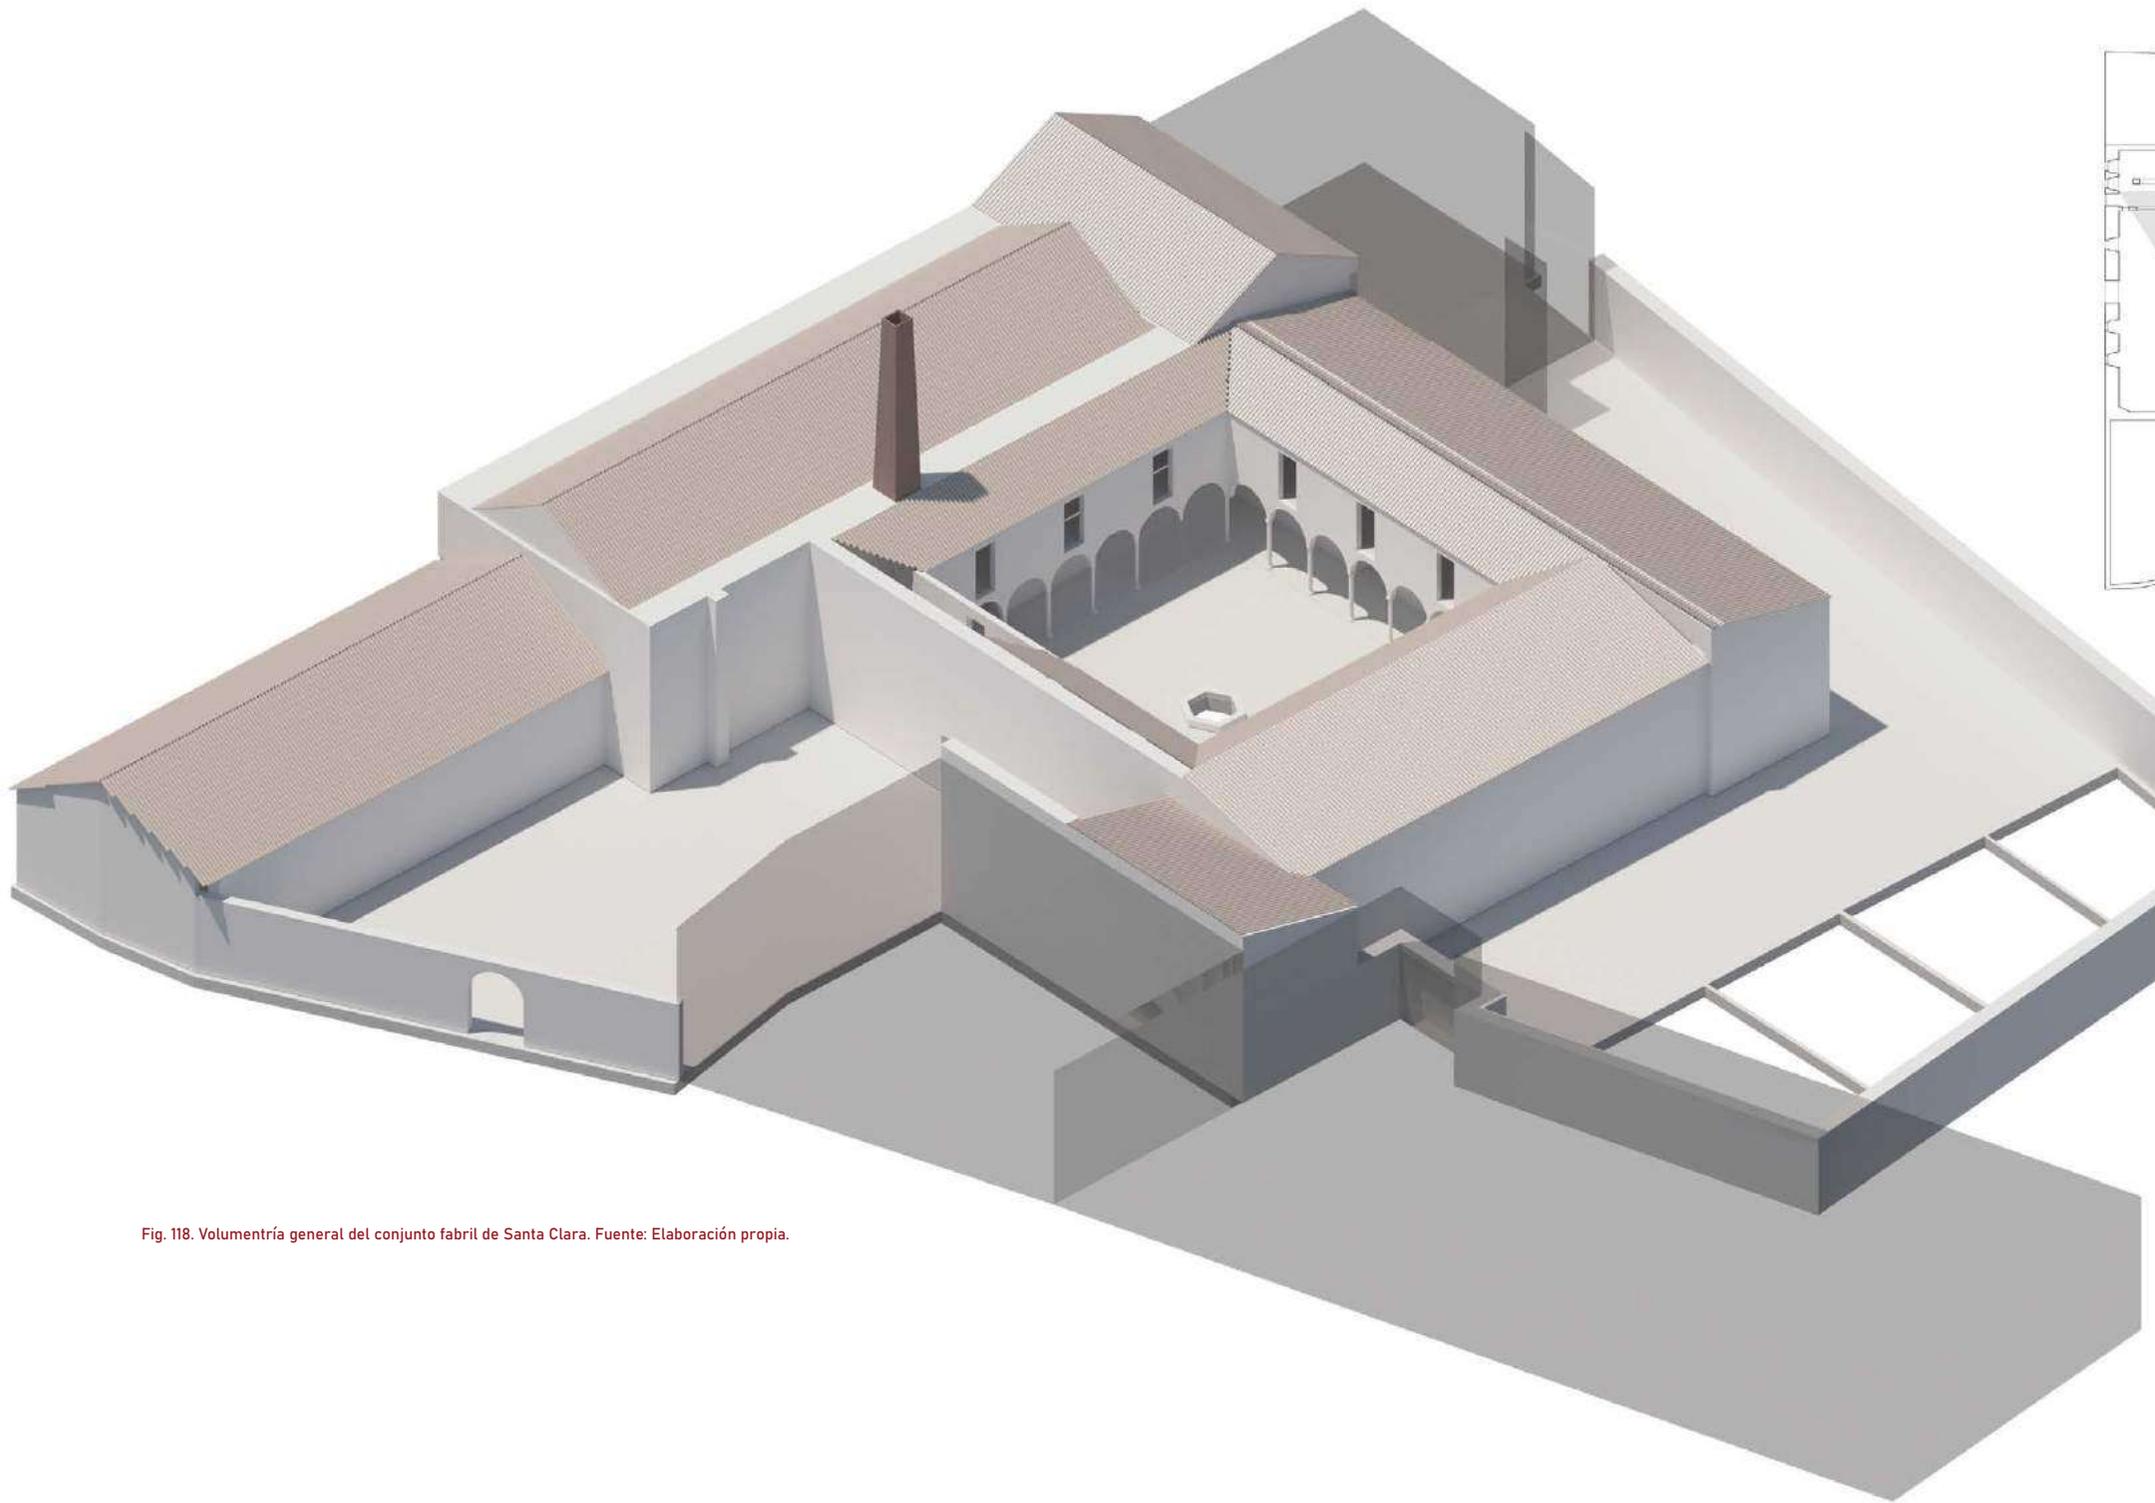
Volumentría general del conjunto fabril de Santa Clara. Fuente: Elaboración propia.
